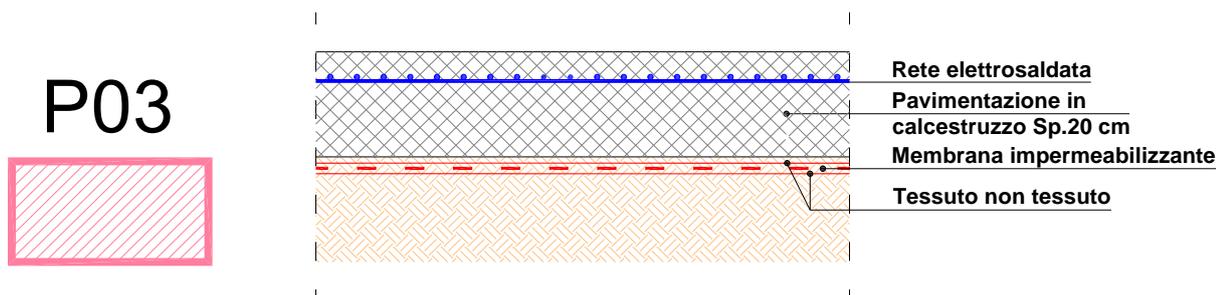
Interventi di pavimentazione tipo P03 – Nuove pavimentazioni impermeabili.
